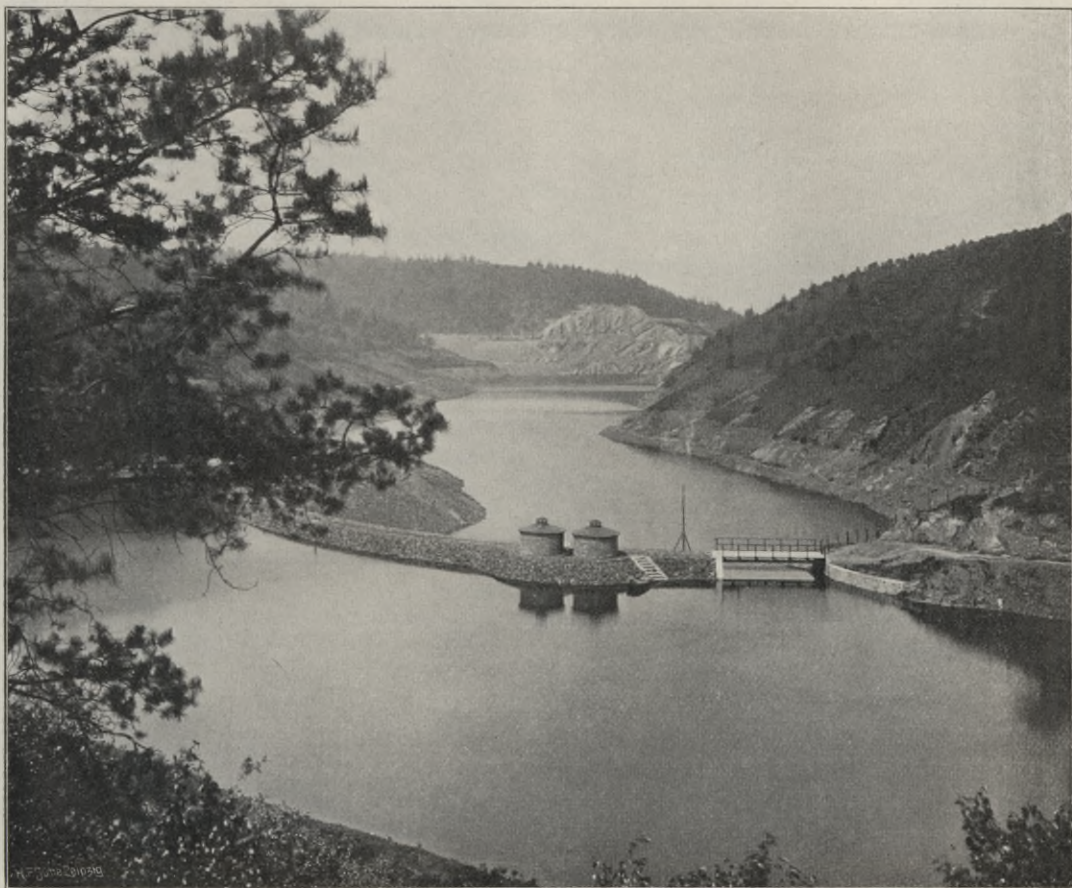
Staffelförmiger Ausbau der beiden Sammelbecken der Stadt Solingen. Das obere Vorbecken ist durch einen Staudamm mit Betonkern, das Hauptbecken durch eine gemauerte Sperre abgeschlossen (s. S. 38).
